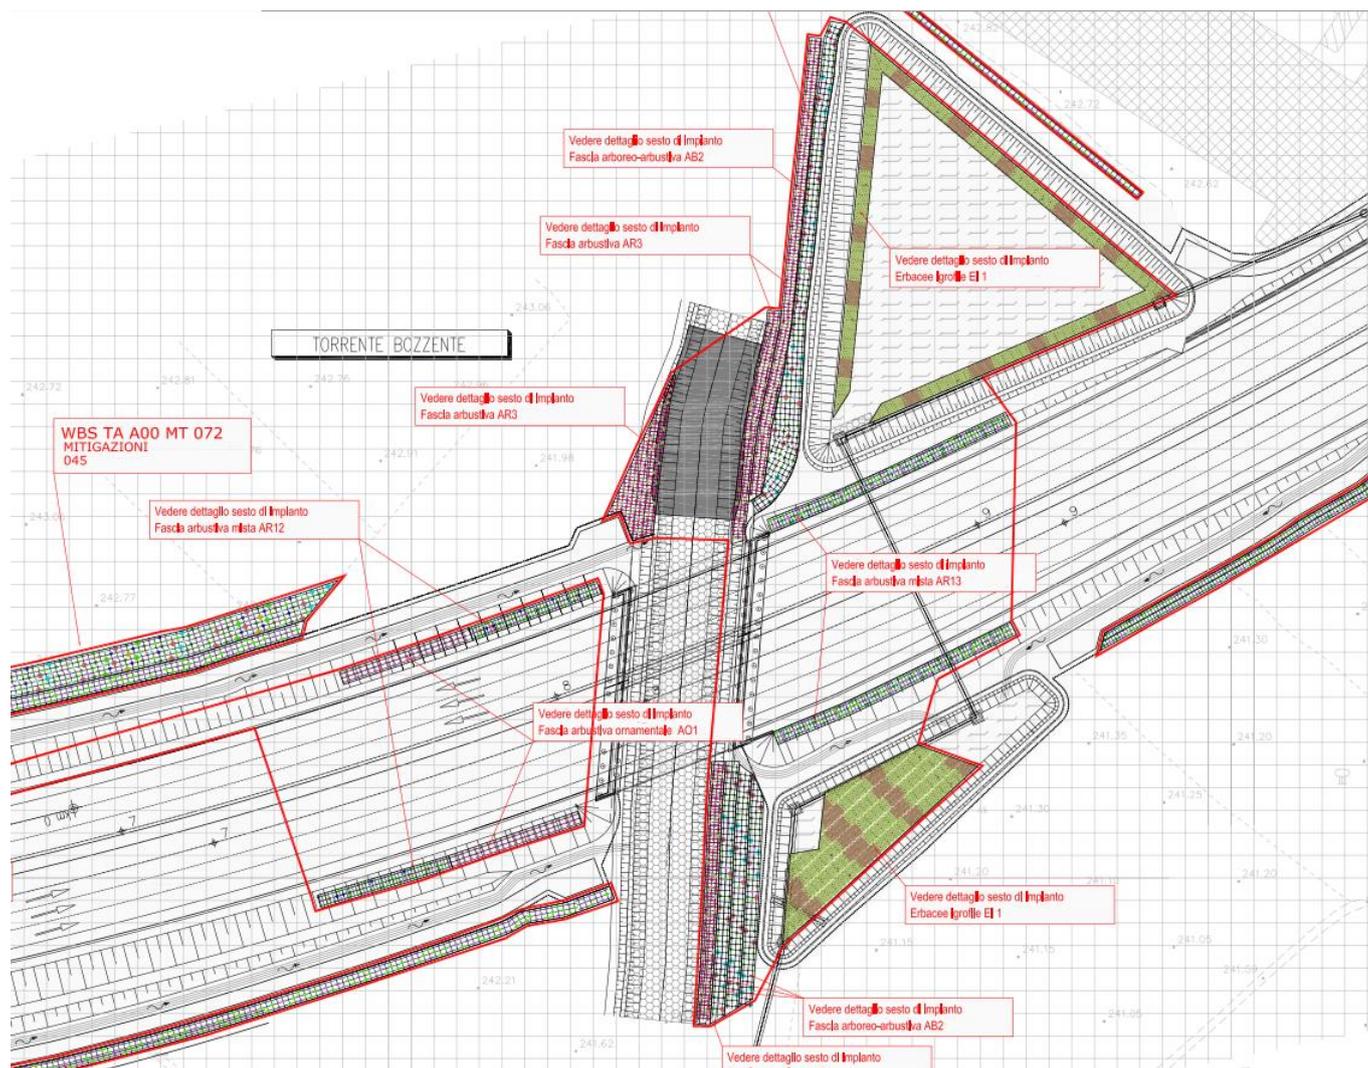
planimetria as built delle mitigazioni a verde nell'area del torrente Bozzente
